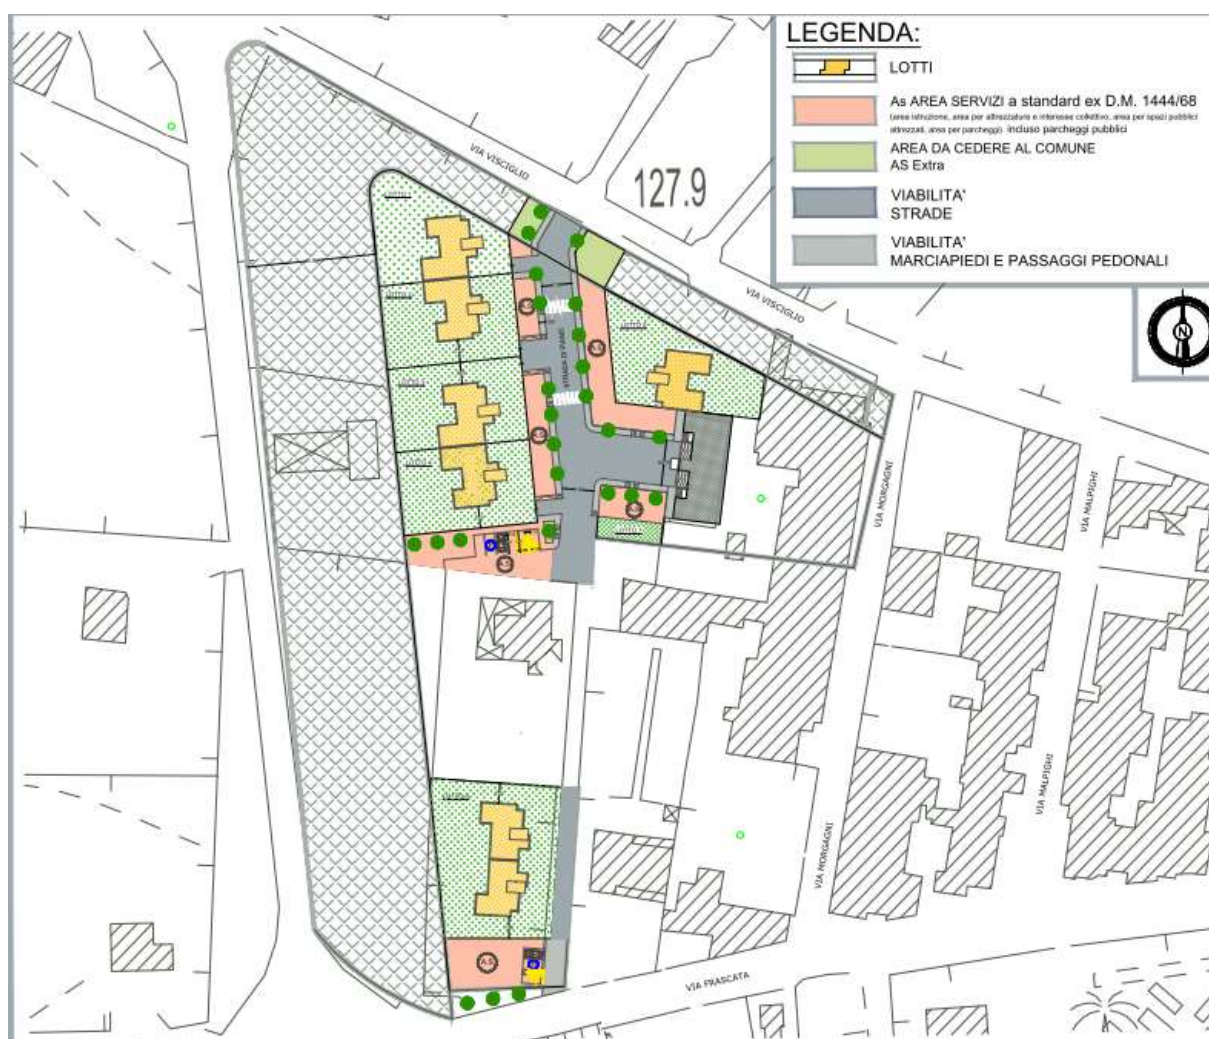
Stralcio della "Planimetria generale Piano di Lottizzazione"
